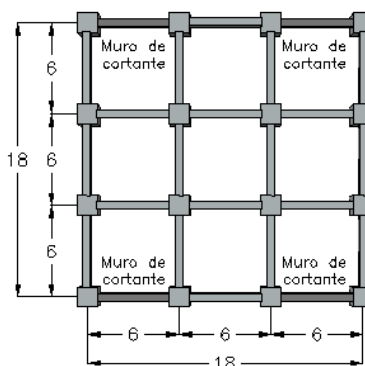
Vista en planta del sistema SD1, que muestra la sección transversal de un muro de cortante que se tomará para el análisis de su capacidad dúctil (acot. m)
